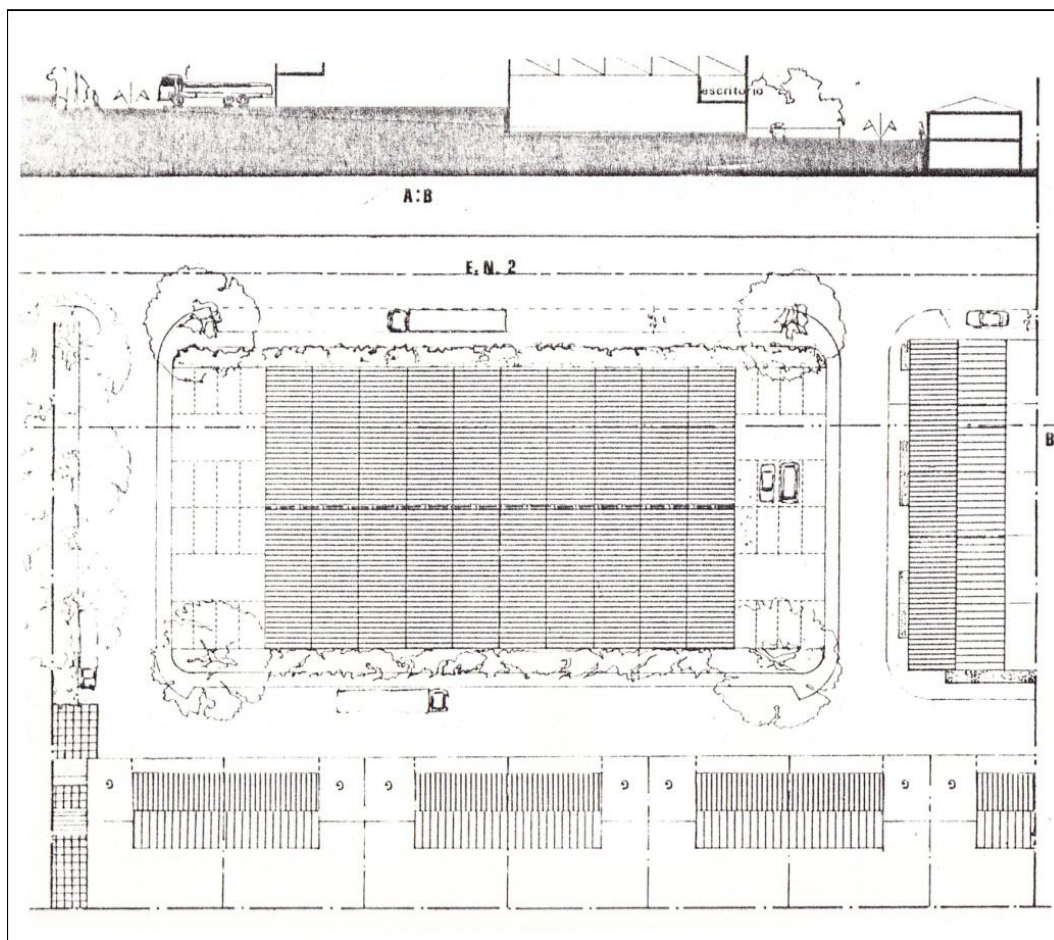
Santa Marta: planta e corte do parque industrial (1982)
